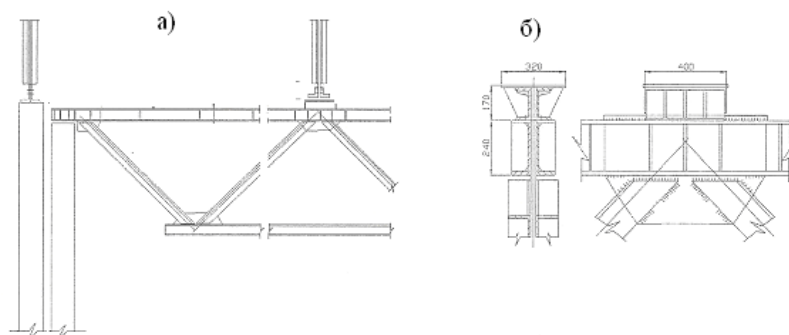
Схема установки подстропильной фермы (а) и узел расположения опорного столика стропильной фермы б)
